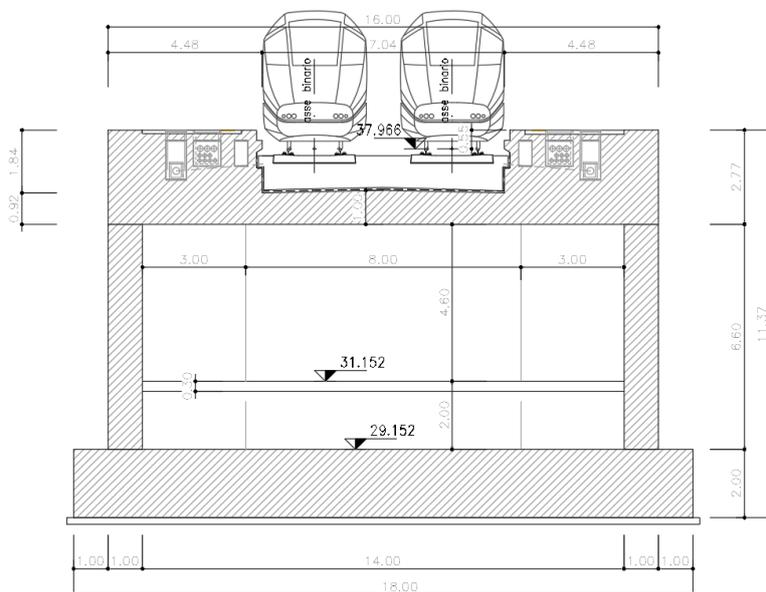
Scatolare di Stazione - Sezione trasversale
